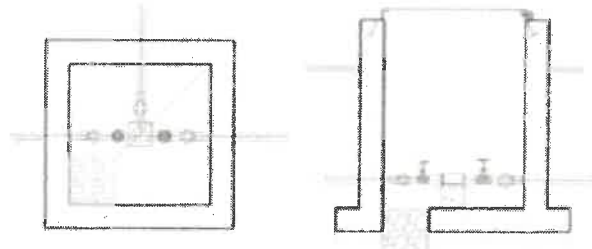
Planta y corte de válvula de control doble del sector Santa Rosa.
